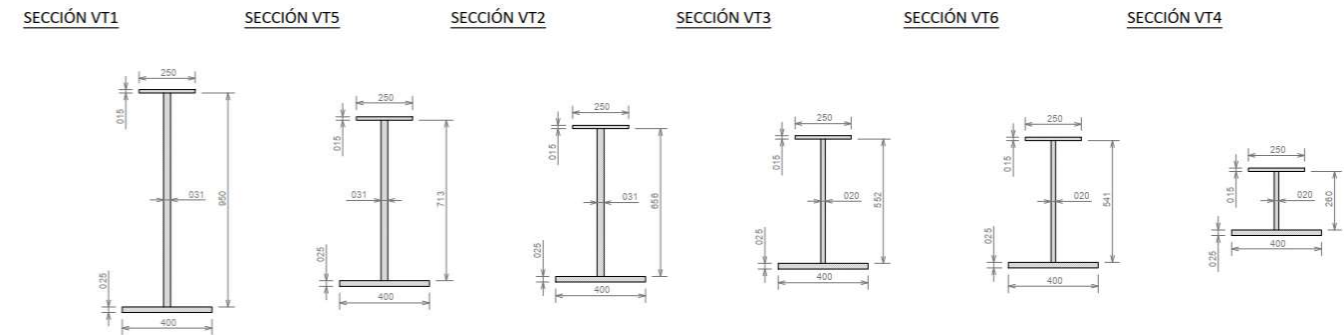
Secciones consideradas para las vigas transversales (fuente: elaboración propia)
